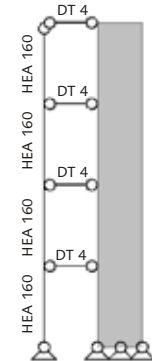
Grundriss Rahmen I - Erschließung
